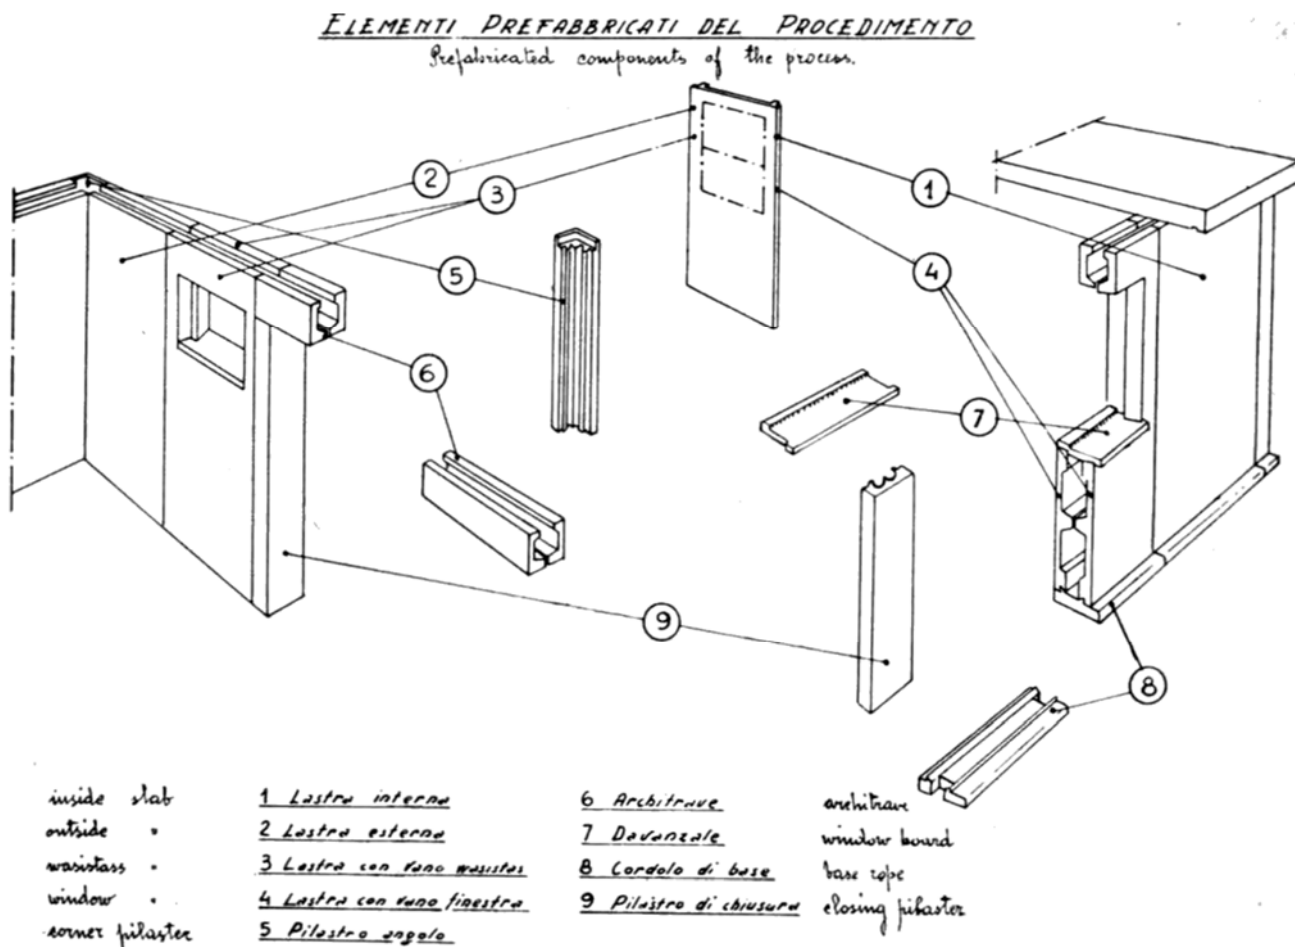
Schema dei principali elementi prefabbricati in calcestruzzo armato per pareti portanti a cassa vuota e partizioni interne secondo il brevetto S.A.C.I.S. – Fonte: Rossi, V. [1960]. “Orientamenti per l’edilizia: elementi prefabbricati”, Atti della Società degli ingegneri e degli architetti - Rassegna Tecnica, n. 5, p. 211
